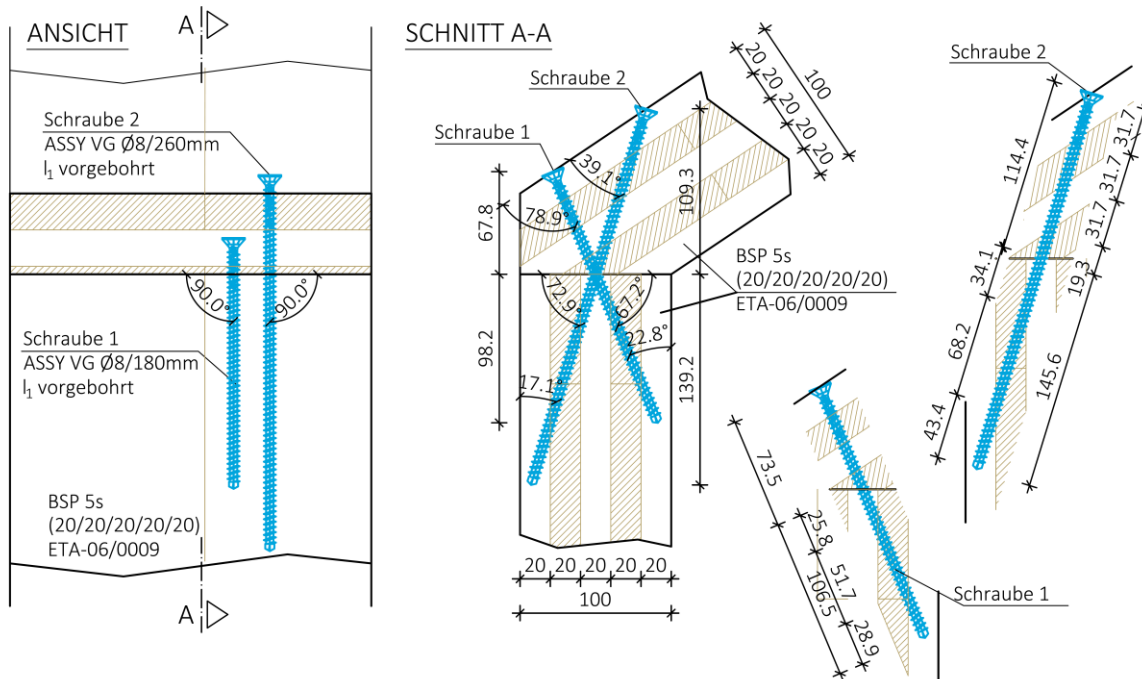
Detail B1 – „Schraubenkreuz 90°“
